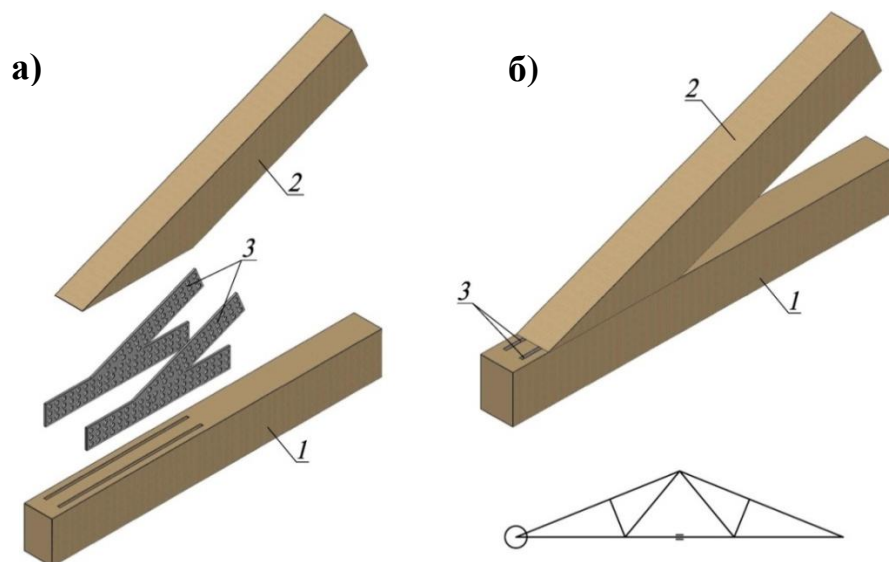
Опорный узел фермы на плоских стальных стержнях в разобранном (а) и собранном (б) виде: 1 – нижний пояс; 2 – верхний пояс; 3 – плоский стержень
